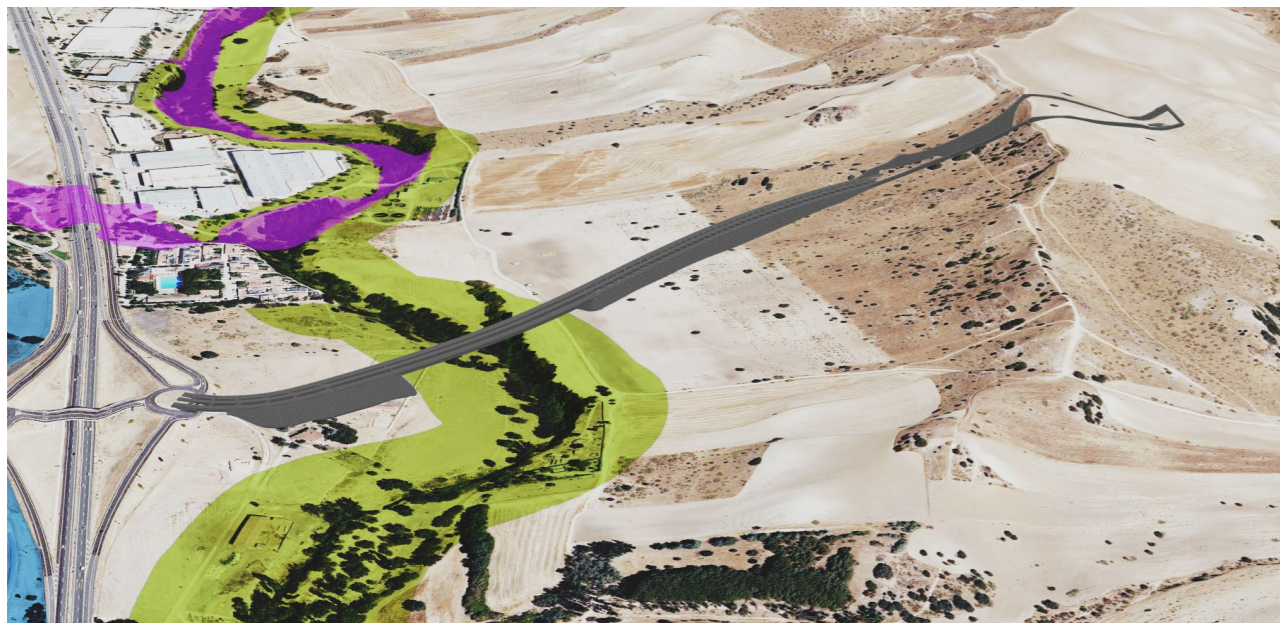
En gris trazado de la Alternativa nº 2 donde se aprecia como atraviesa el ZEC del río Guadalix
